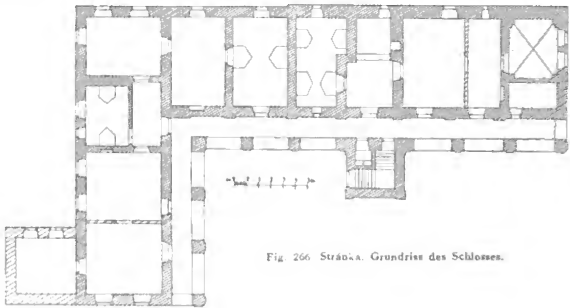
Stránka. Grundriss des Schlosses.
